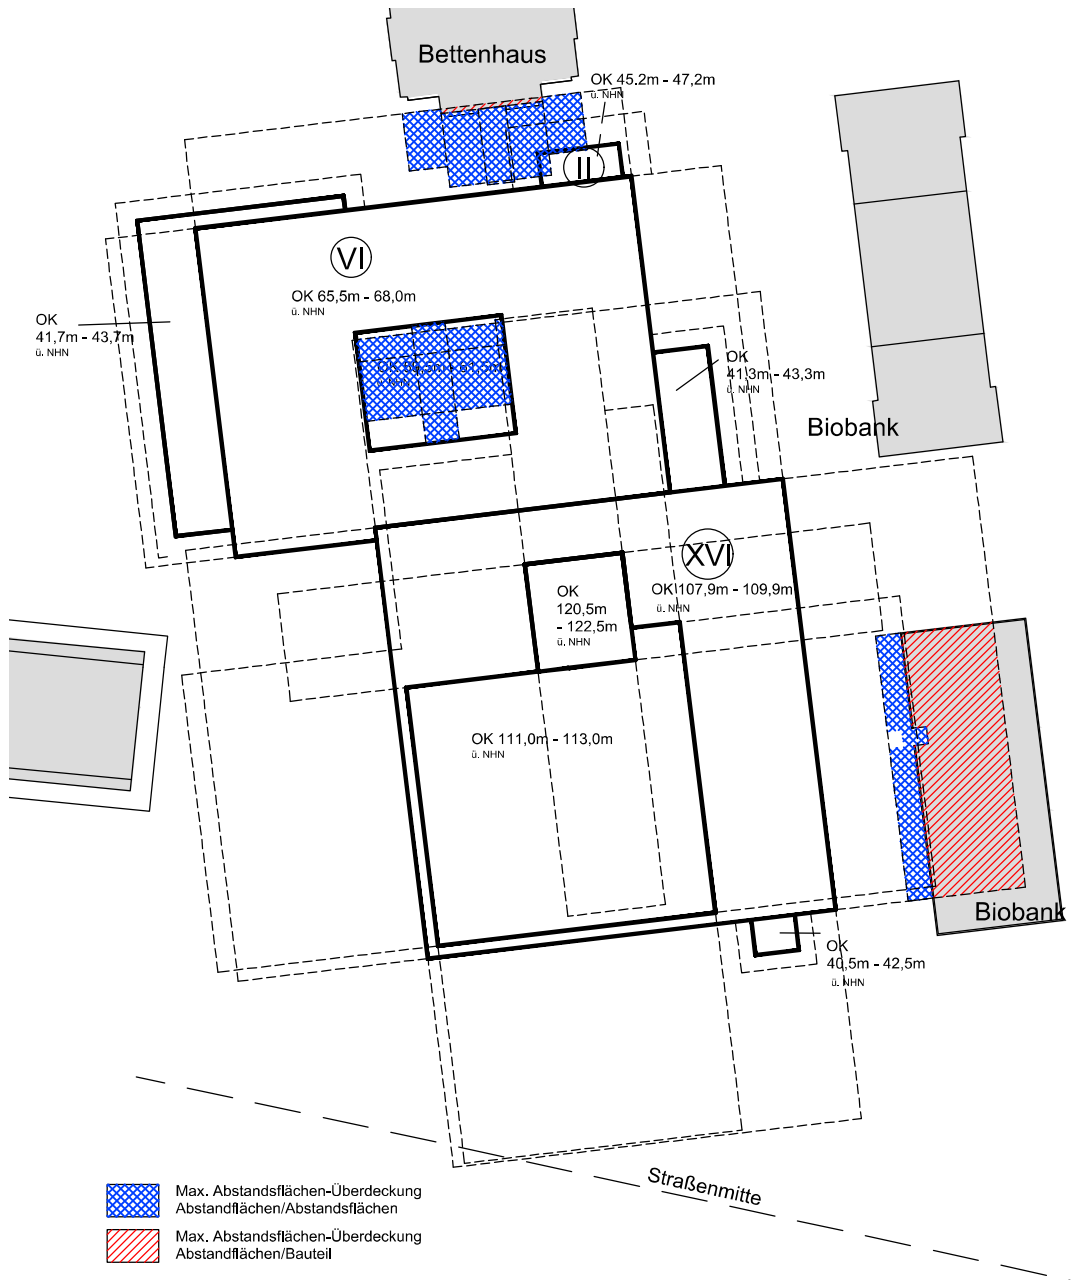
Abstandsflächen und Abstandsflächenüberdeckungen, Quelle: Machleidt GmbH Städtebau + Stadtplanung
